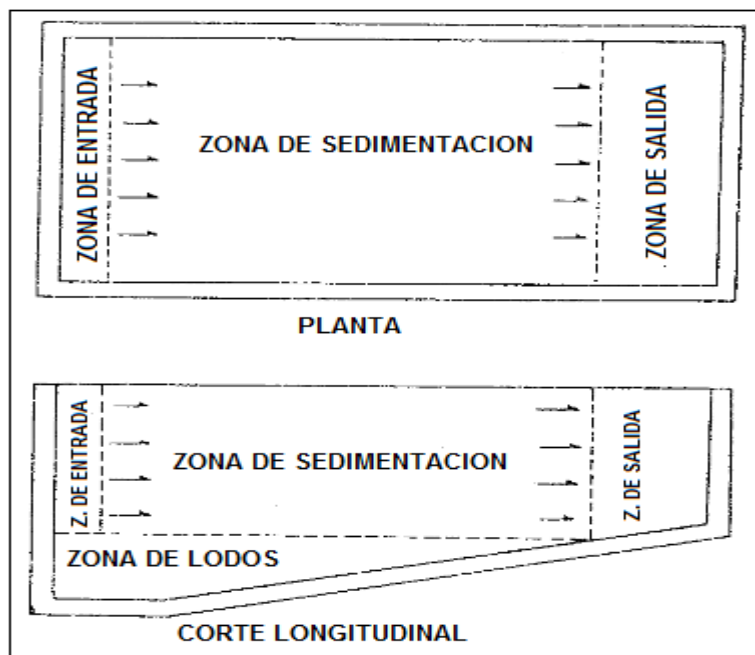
Planta y corte longitudinal del desarenador (1 pendiente)
